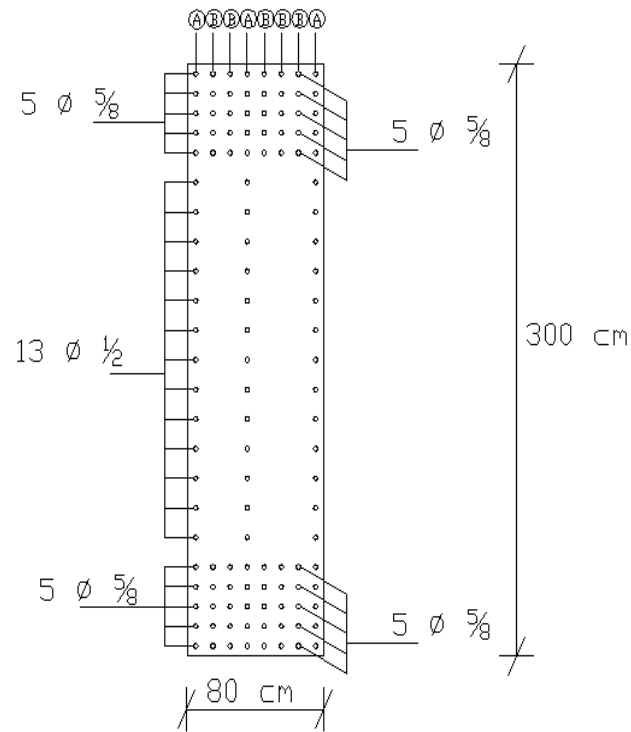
Sección transversal de muro dirección X nivel PB.
